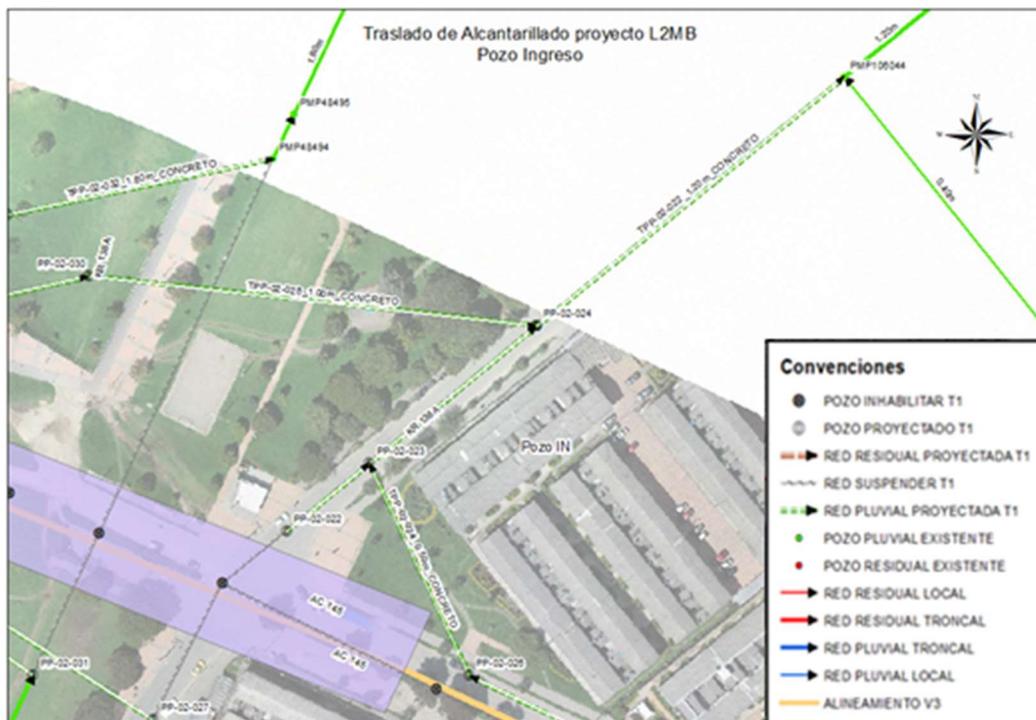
Traslado de redes de Alcantarillado Pozo de Entrada Carrera 138A con Calle 146 Red Pluvial
